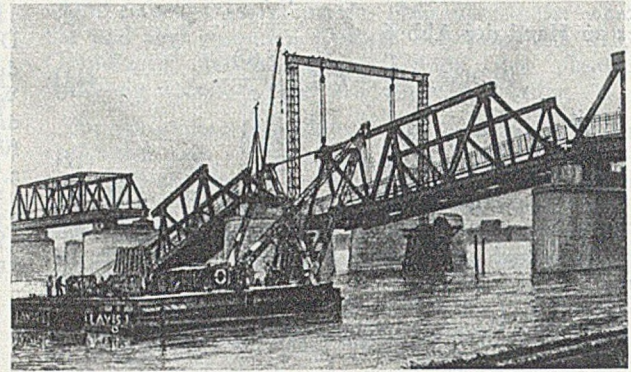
Hebung der Eisenbahnbrücke mit elektr. betriebem Hubgerüst.
